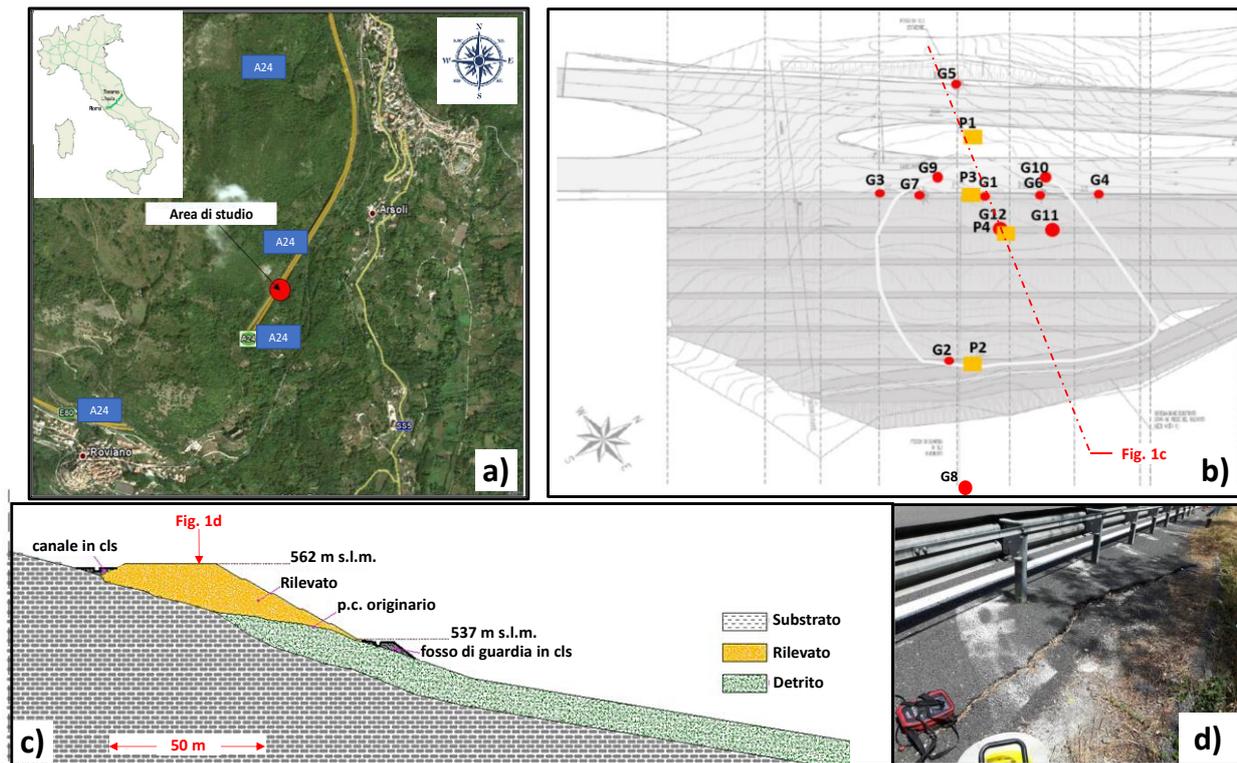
Il caso di Roviano: a) area di studio (fonte Google Earth); b) posizione planimetrica dei sondaggi; c) sezione di riferimento; d) lesioni osservate sulla pavimentazione stradale.
